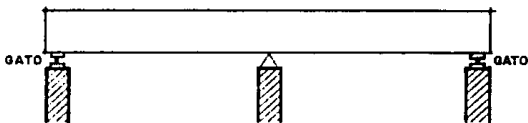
PRESFUERZADO DE UNA VIGA CONTINUA APLICANDO GATOS EN SUS REACCIONES.
